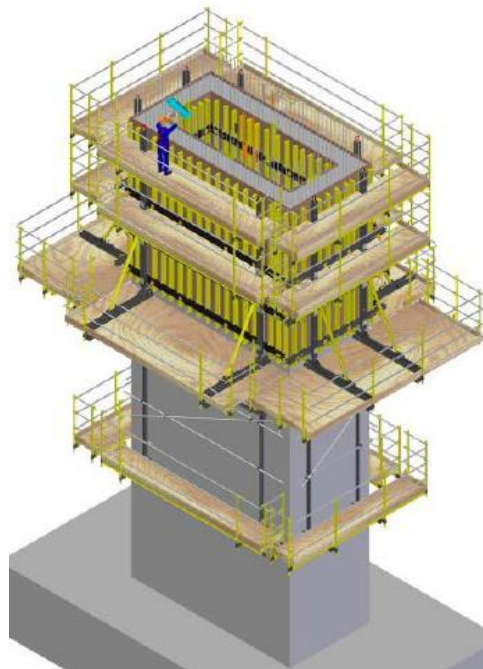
an. Colado de la tercera tongada. Recuperado de: Ulma Construction, *Instrucción técnica de montaje*.
